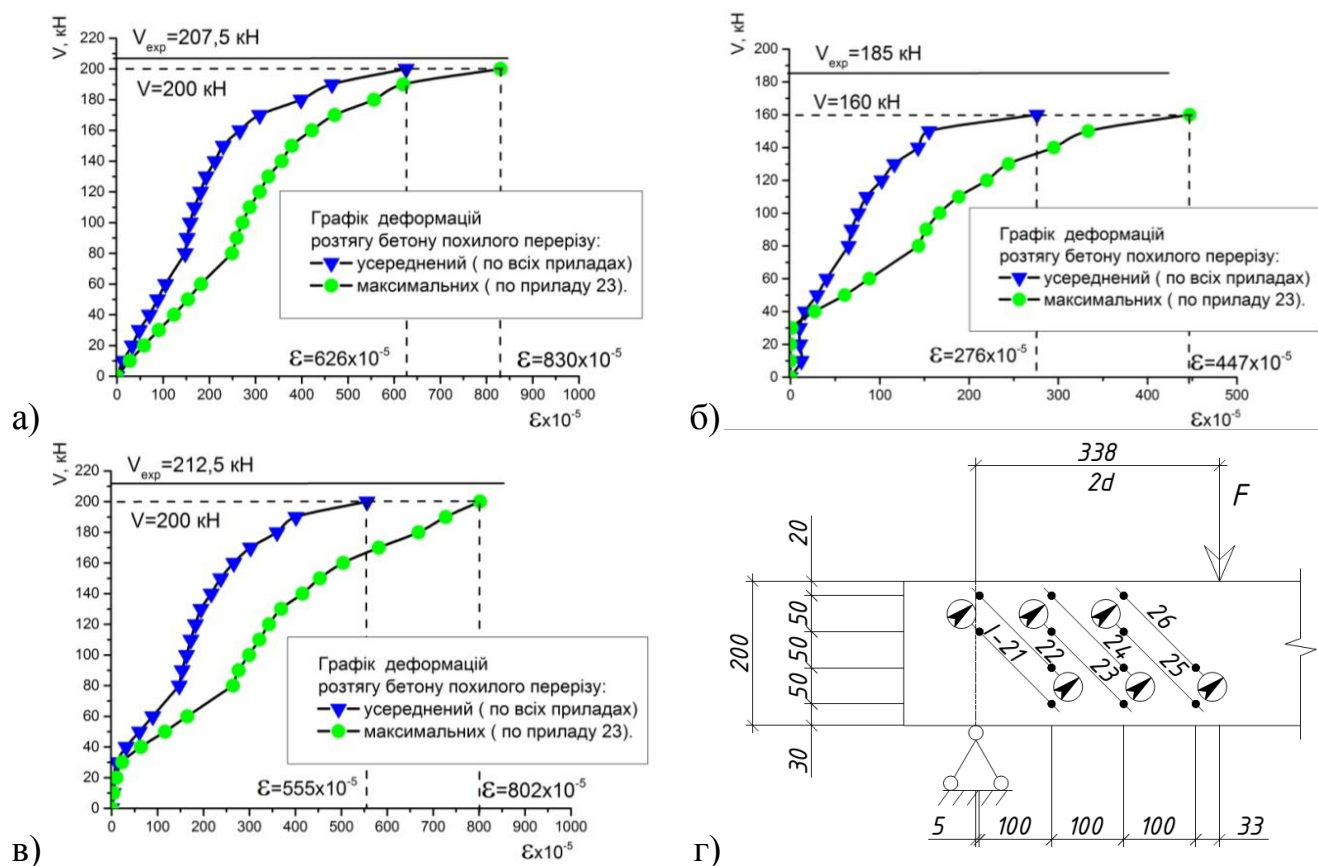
Деформації бетону похилого перерізу балки: а) БПК 2.5-0.5пс; б) БПК 2.6-0.5кс; в) БПК 2.7-0.5нс; г) схема розташування приладів на поверхні бетону
